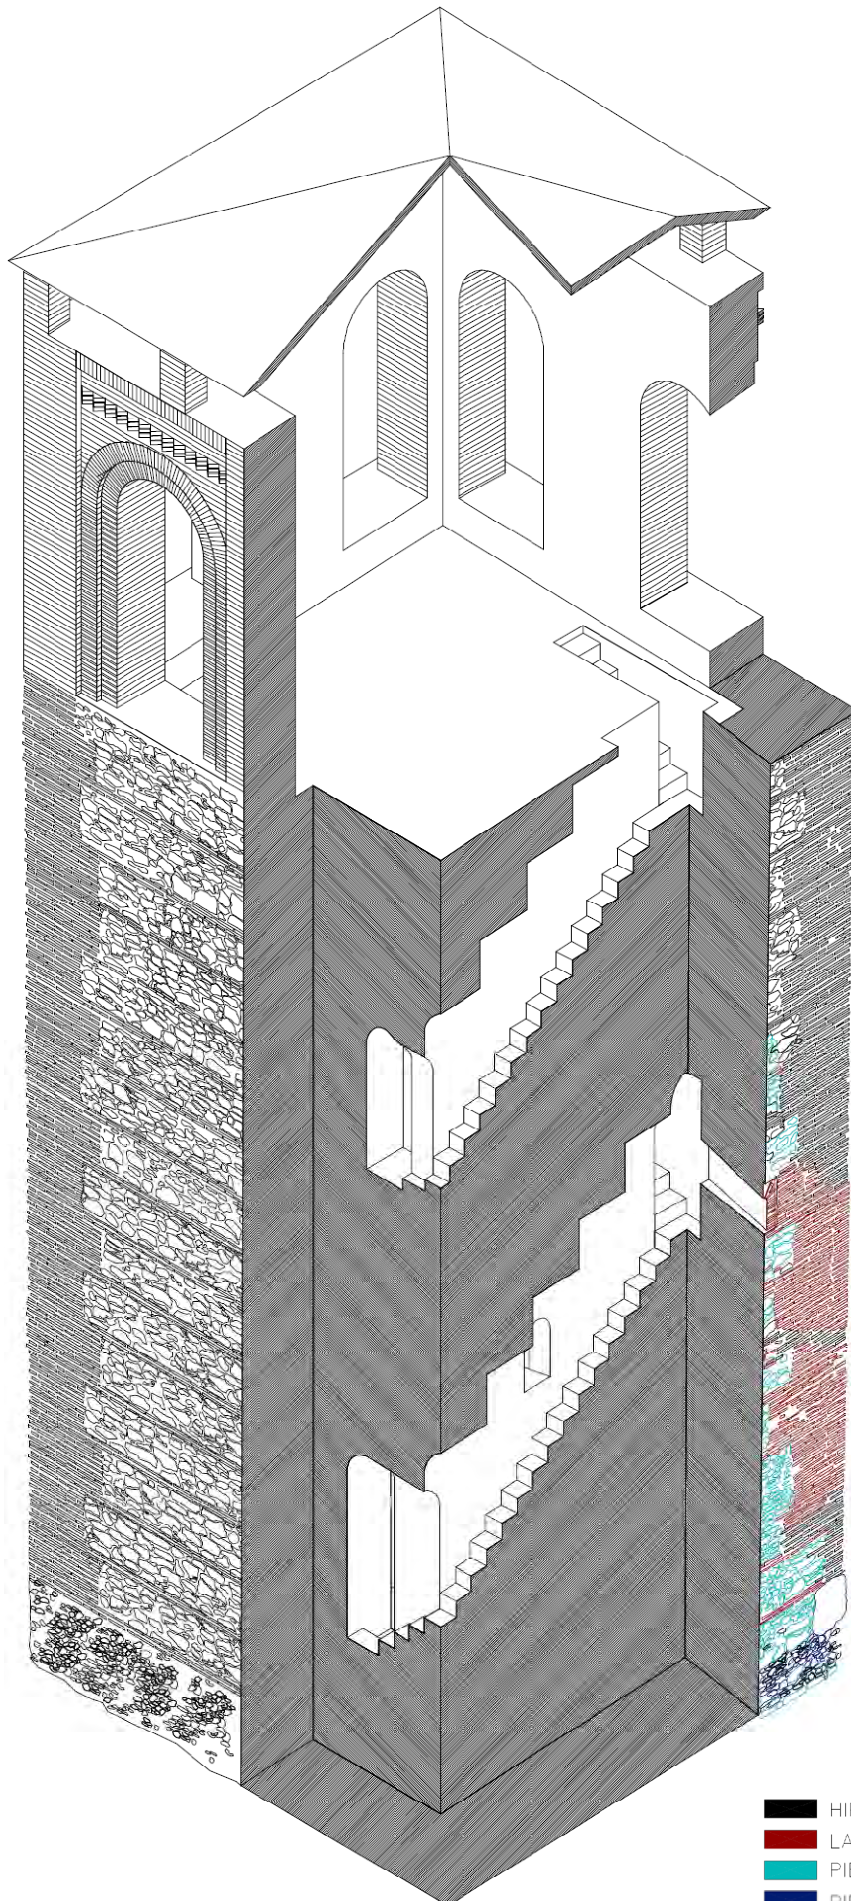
axonometría seccionada por las escaleras de comunicación encastradas en el muro.
